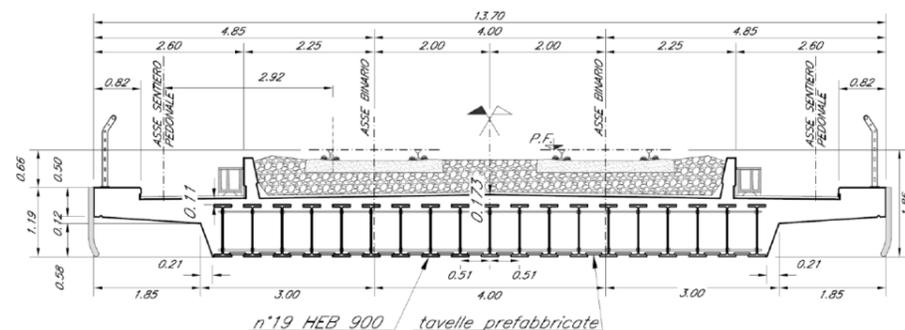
Sezione trasversale campata isostatica – Doppio binario
